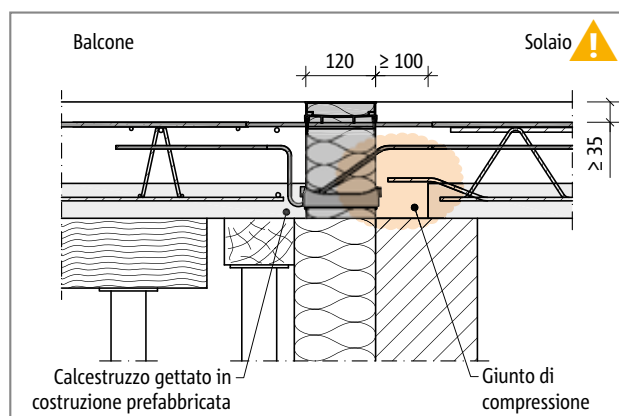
Schöck Isokorb® tipo KFXT: giunto di compressione lato solaio collegato a piastre prefabbricate; appoggio diretto
